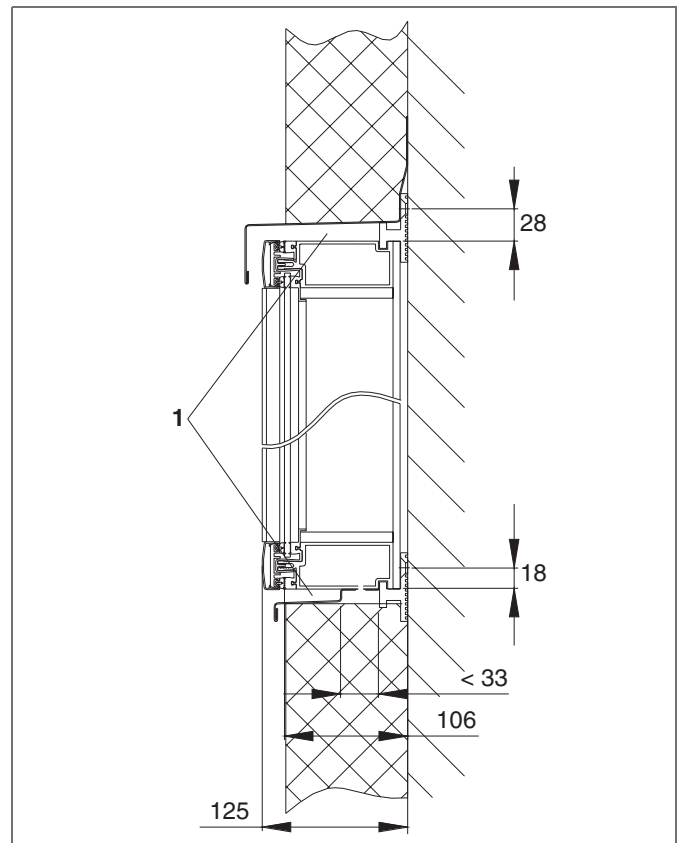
Fassadeneinbindung (Vorschlag)
